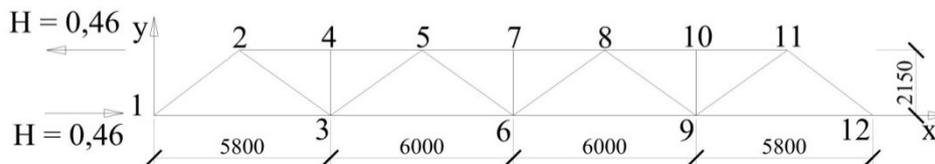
Розрахункова схема для визначення зусиль в стержнях ферми від дії розпору рами.
